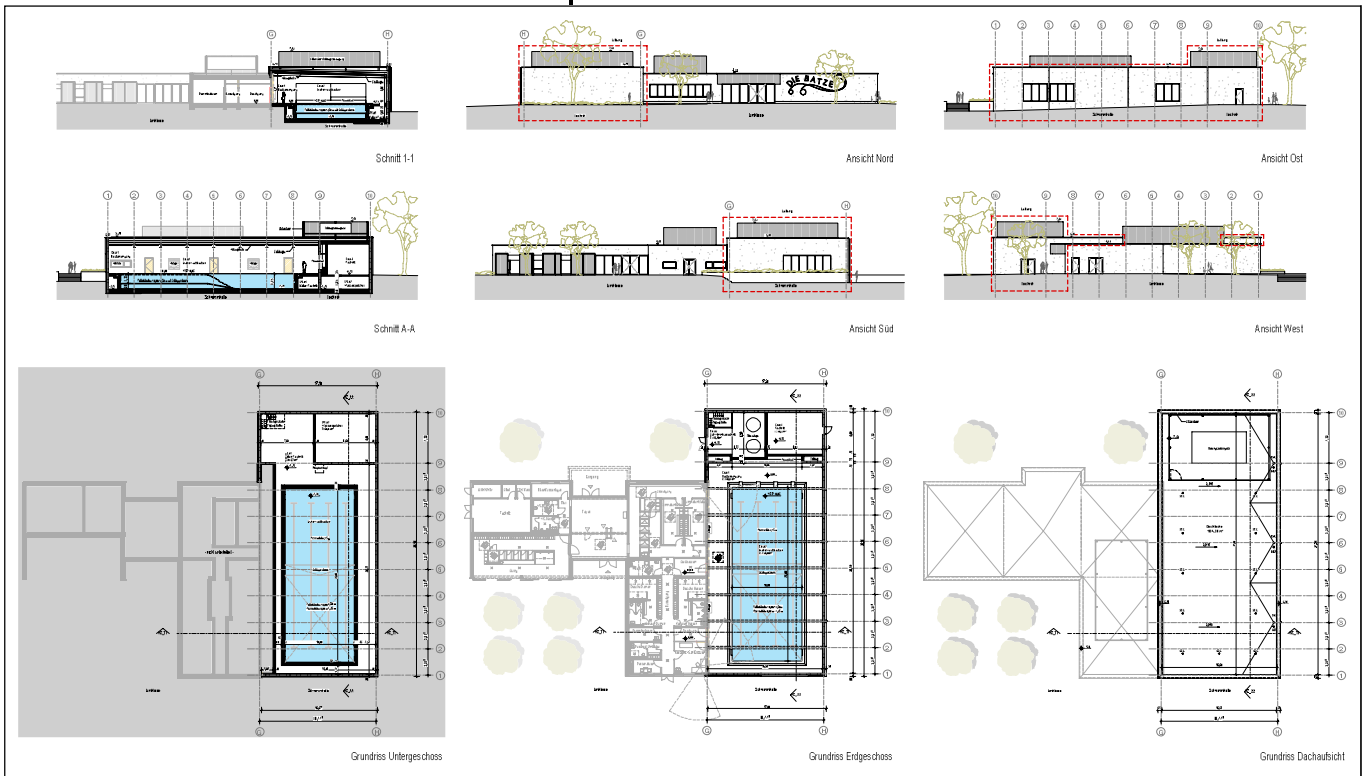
Schnitte, Grundrisse Ersatzneubau Hallenbad Beverungen Kernstadt, pbr Planungsbüro Rohling AG, Stand 28.10.2020, Förderantrag „Wohnviertel im Wandel“ 10/2023
